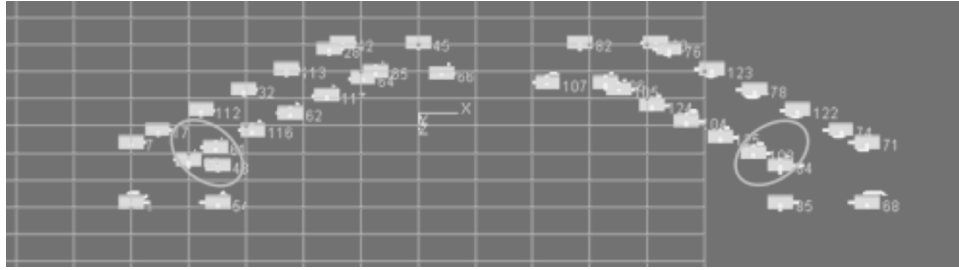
Grupo Zapatas Aisladas Vista Planta
